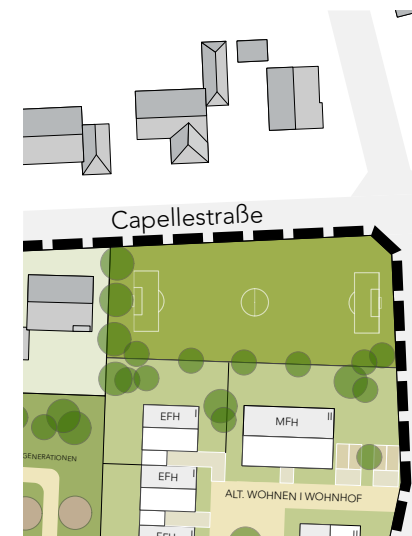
| Bolzplatz Ecke Capellestraße / Schulstraße
